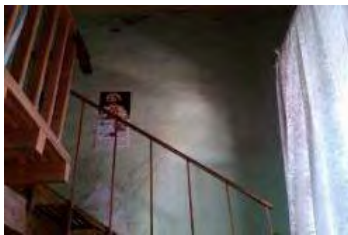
Presencia de grietas y mezanine empotrado en los muros de la recamara (1)
